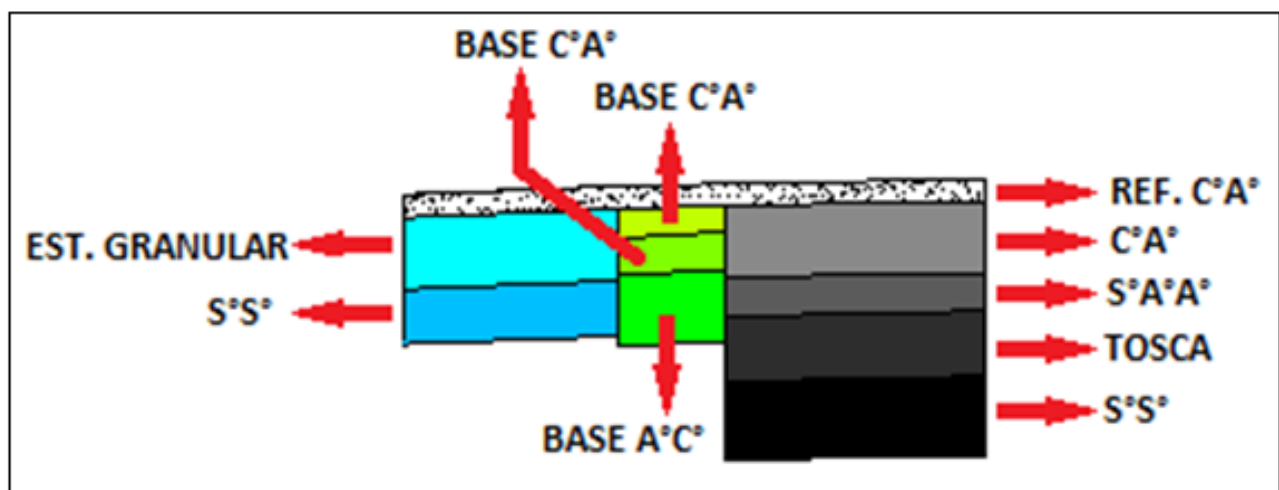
Detalle del paquete estructural – Fuente: Elaboración propia
